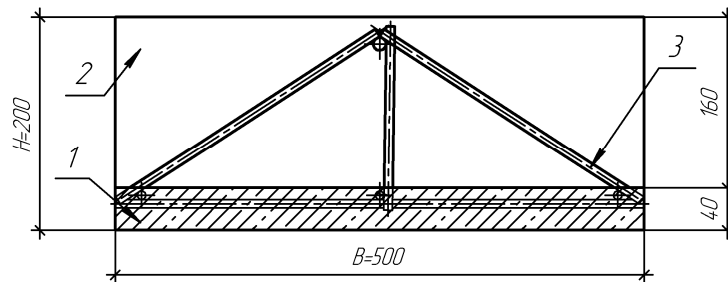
Поперечний переріз короткої збірно-монолітної залізобетонної плити перекриття з використанням пінобетону:
